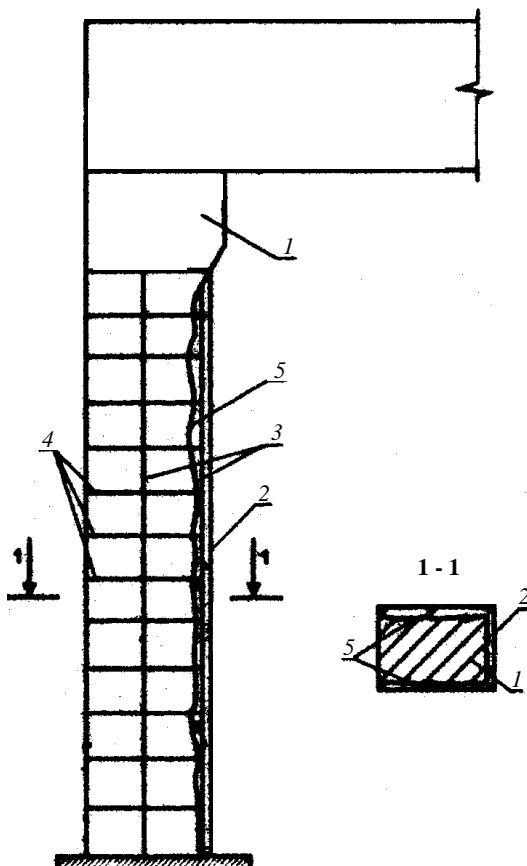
Устройство железобетонной рубашки при усилении колонны:
